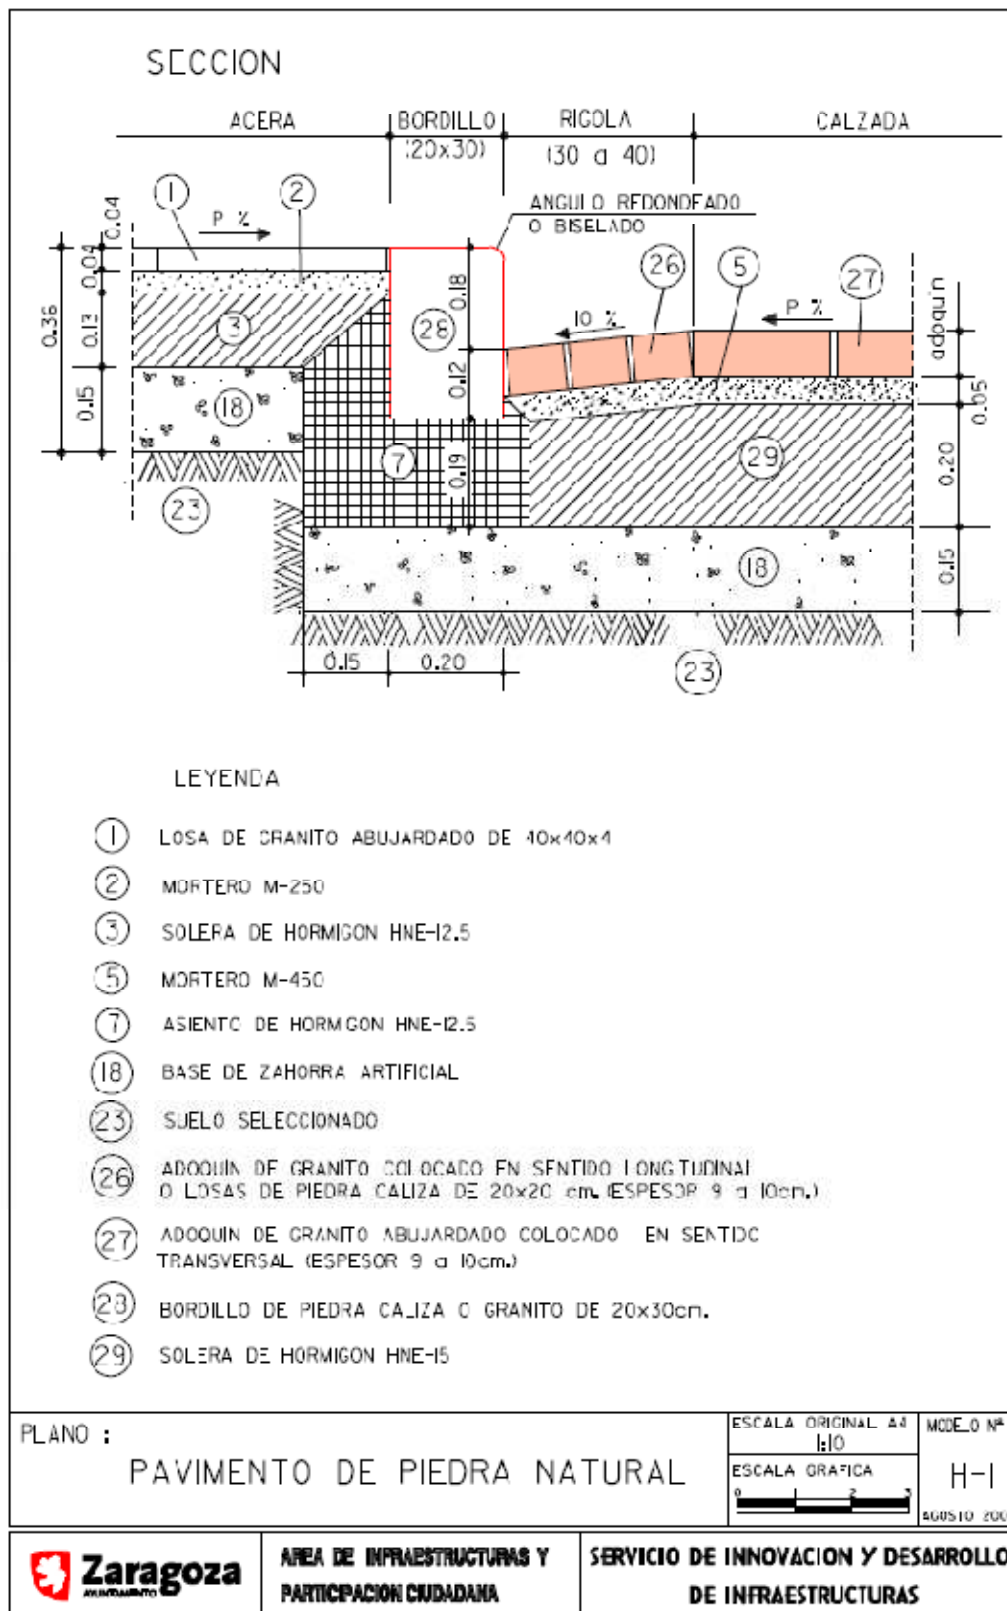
Sección tipo pavimento de piedra natural H-1 (Fuente: Web Ayuntamiento de Zaragoza, julio 2010)
